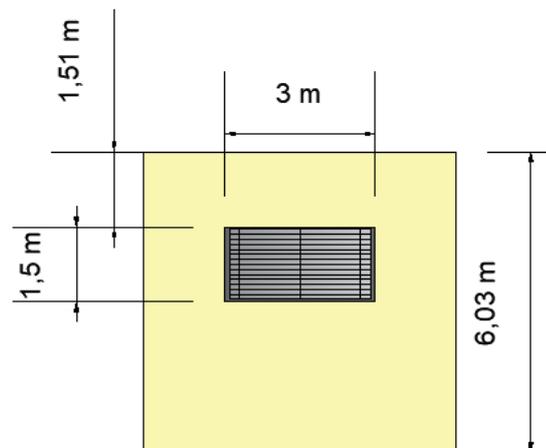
Vista frontal de una rejilla de ventilación empotrada en pared
